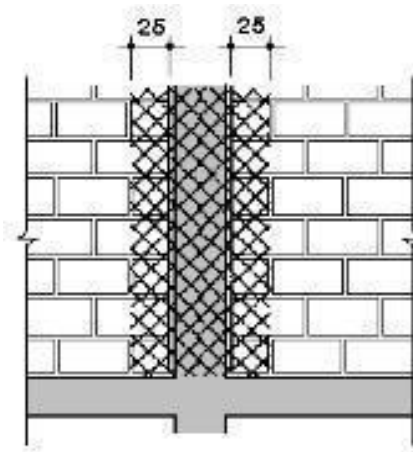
Método de costura das fissuras nas ligações das paredes com pilares da estrutura.
